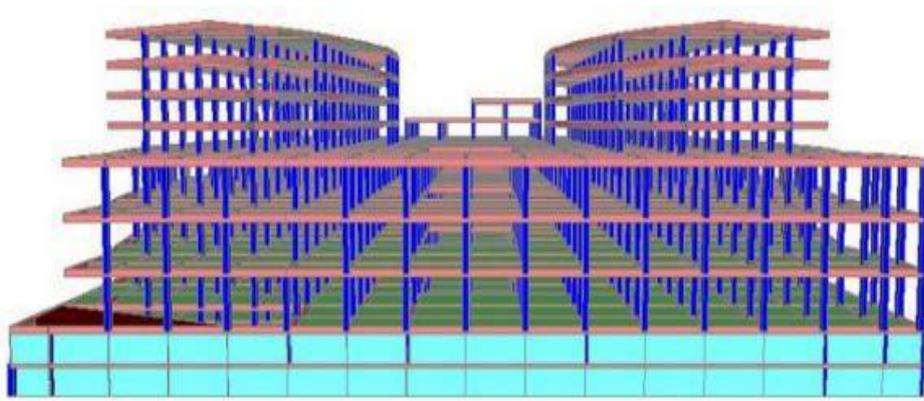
La structure du centre du centre commercial de Bâb Ezzouar.
